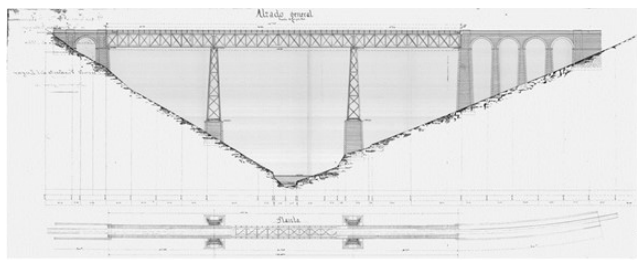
Alzado y construcción. Puente Arroyo Lugar, número 6 (EB). En los planos, se lee: Société Anonyme de Construction el des Ateliers de Willebroeck Dessign n° 654, Expedition n° 662, Paris le 27 julliet 1884 y Bruxelles n° 5930 y n° 869. Ingeniero Jefe Bayoin.
